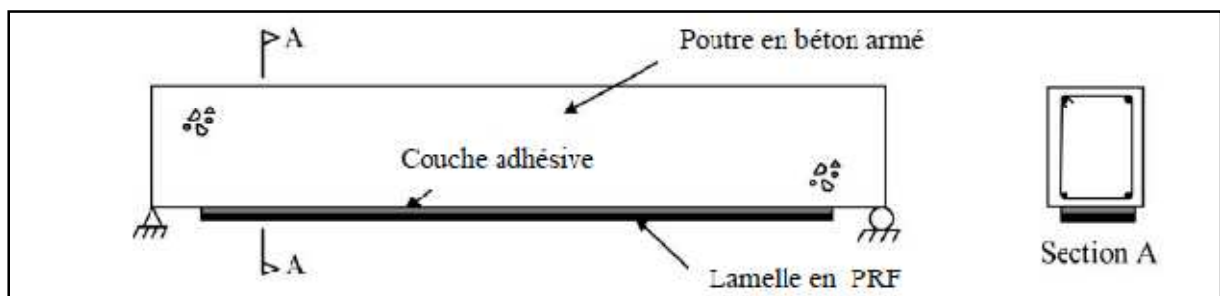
Une poutre en béton armé renforcée par une lamelle en PRF [23]
